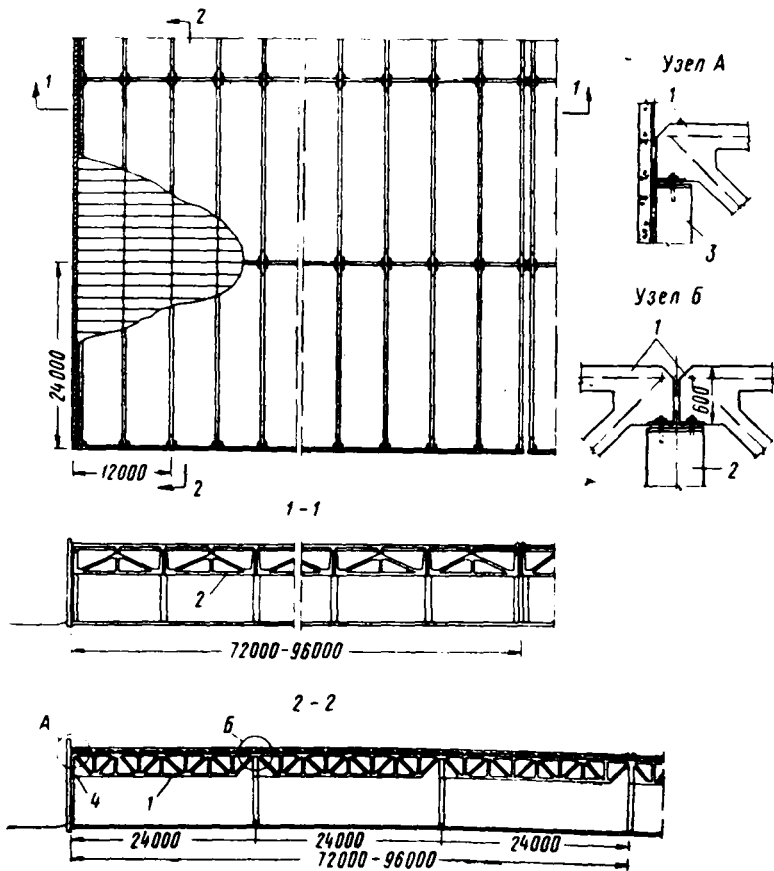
Конструкции зданий с плоской кровлей с опиранием в верхних узлах ферм
